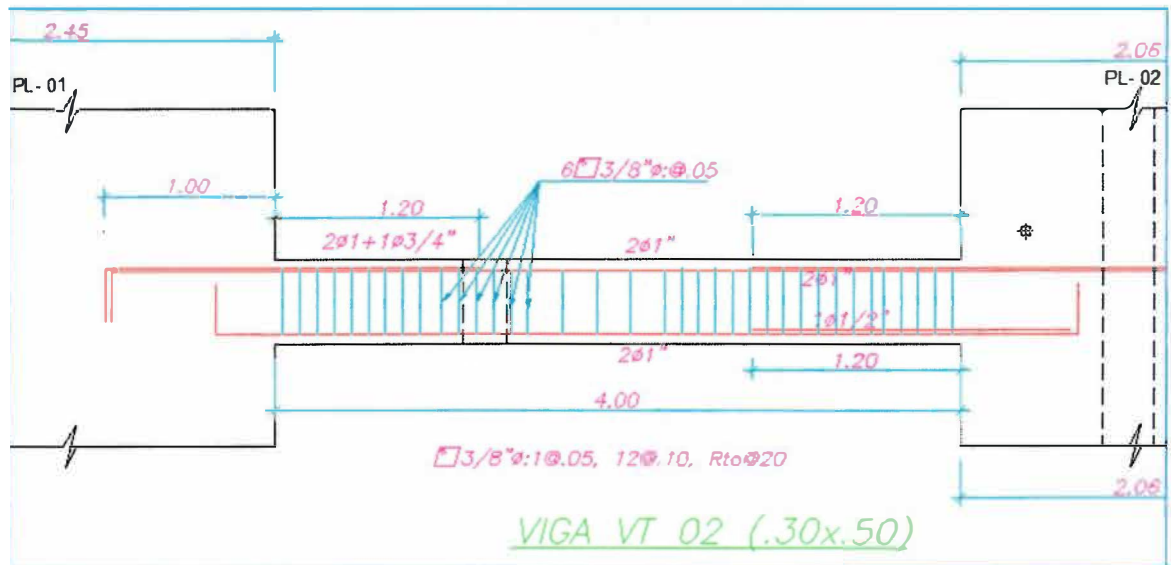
b: Armadura de Viga VT 02 1er al 7mo piso
